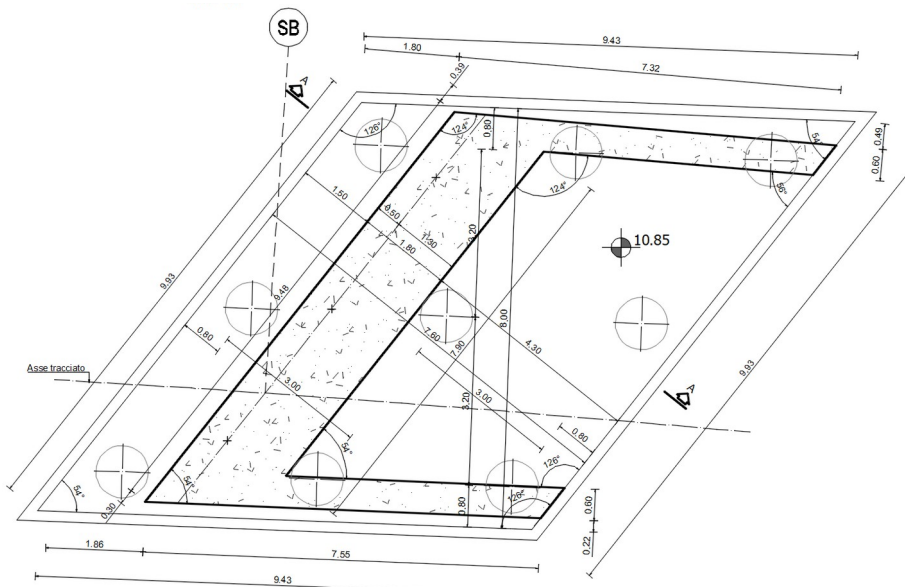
platee su pali – spalla "SB" lato Ramo Bidirezionale 1
